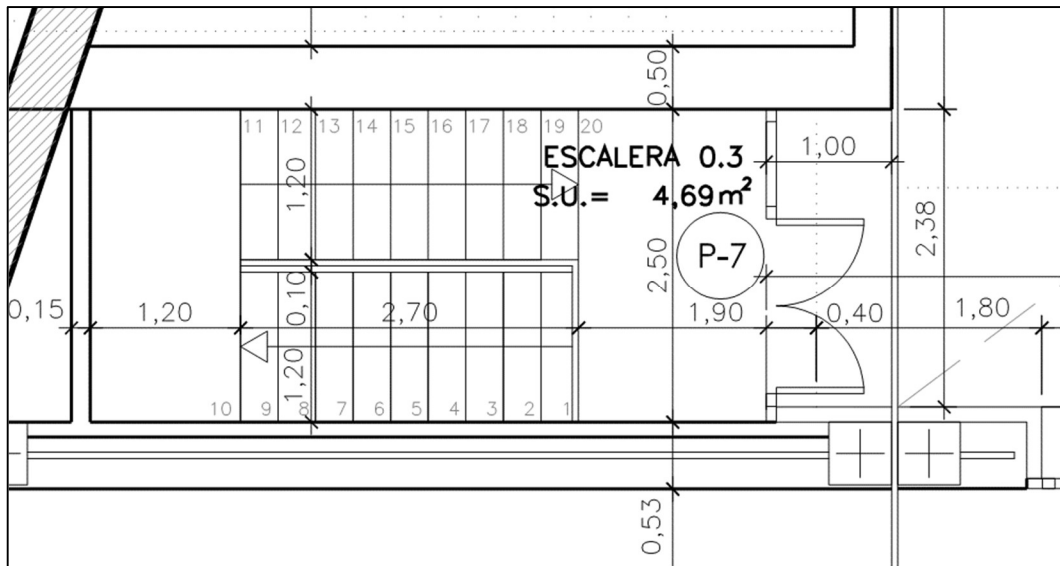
Escalera 0.3. Evacuación ascendente Garaje -1 con Planta Baja.
